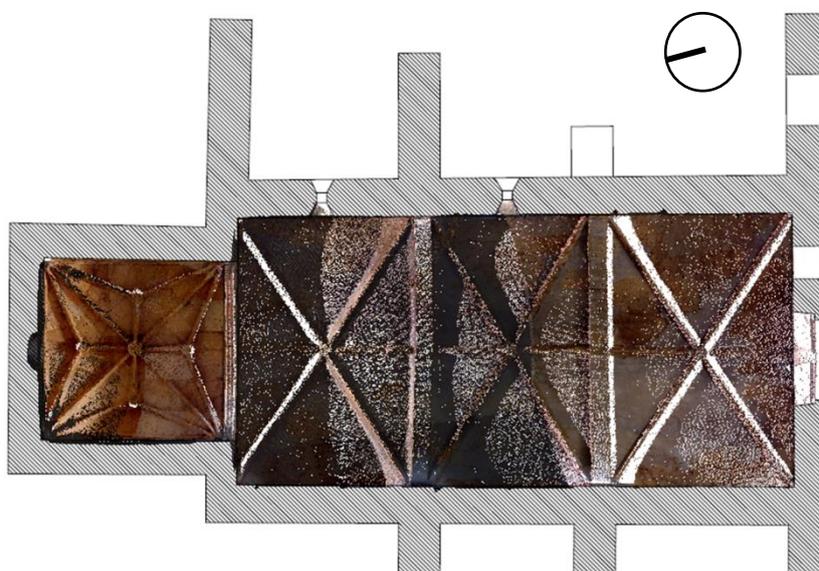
Planta cenital de la Ermita, con proyección nube de puntos.
